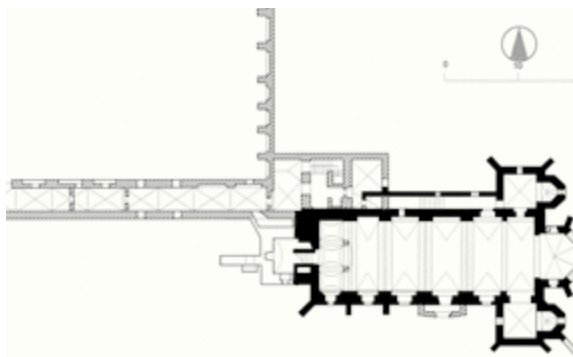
Grundriss des ehem. Zisterzienserinnenklosters St. Bernhard
